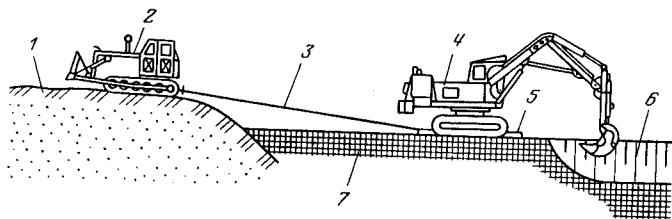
Схема разработки траншей на болотах I и II типов экскаватором, находящимся на пено-волокуше:
